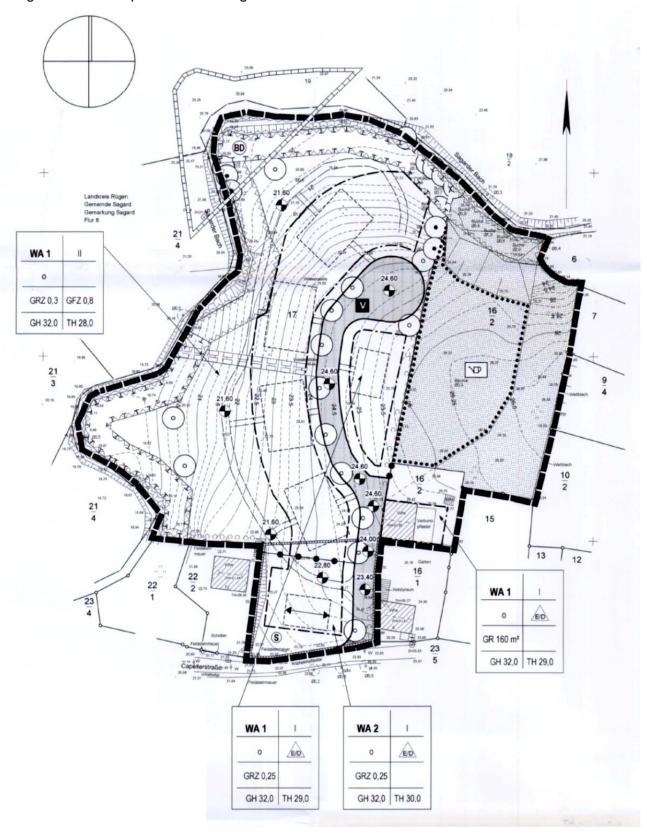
Ursprungsplan, Planzeichnung ohne Maßstab
